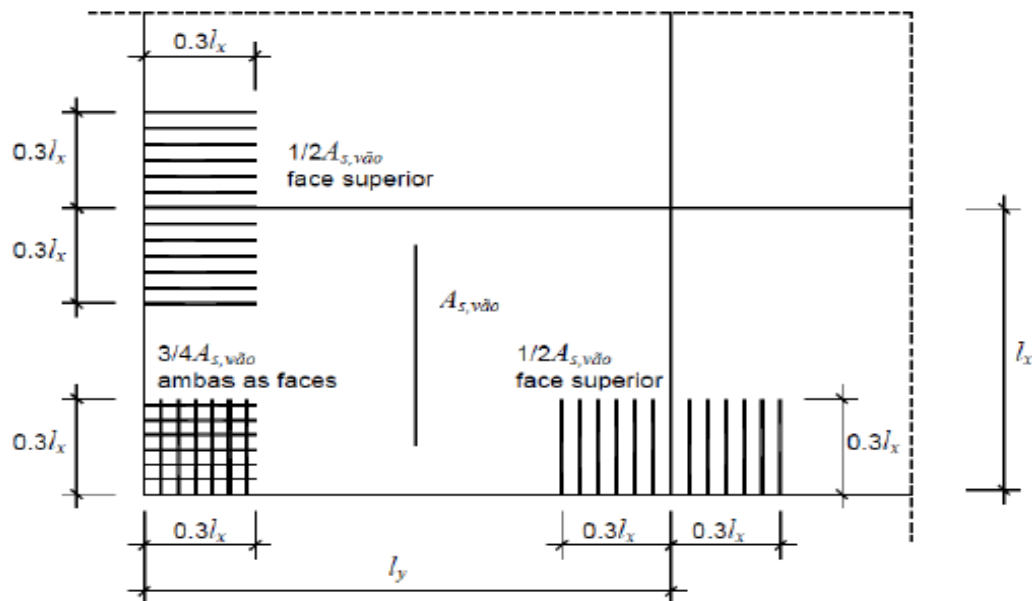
Armadura de Canto e Armadura de Bordo Simplesmente Apoiada
